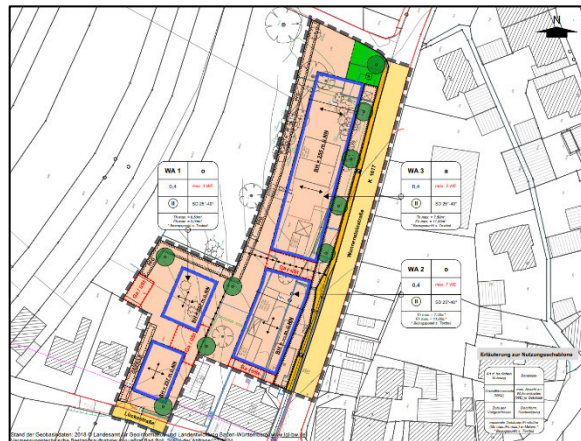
Auszug Bebauungsplan ‚Wunnensteinstraße‘ [24]
